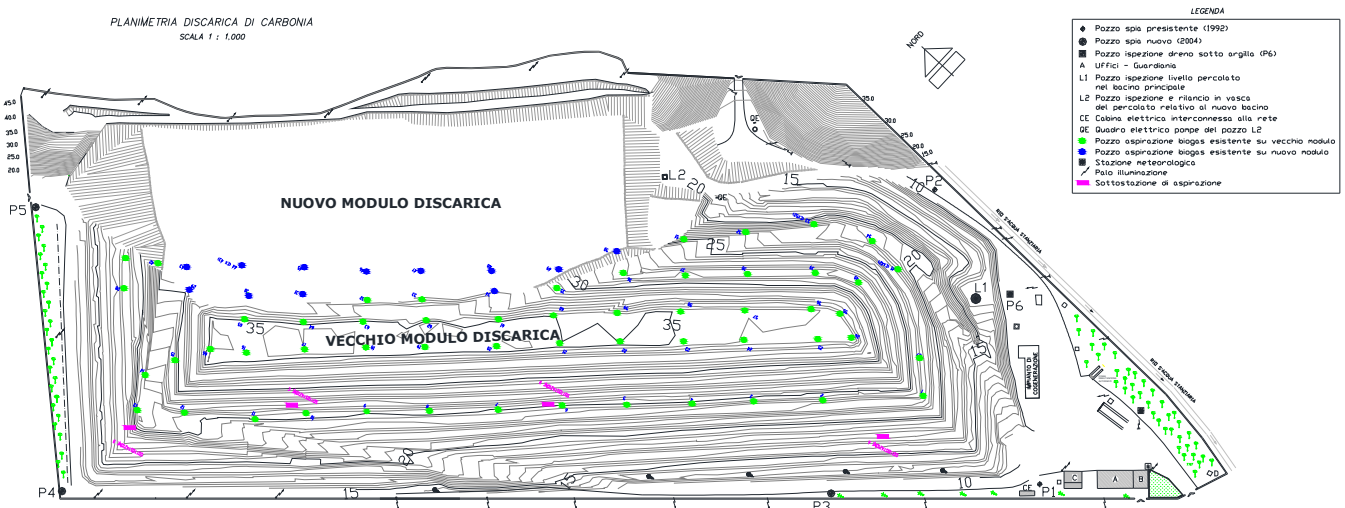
Planimetria attuali pozzi di estrazione del biogas
